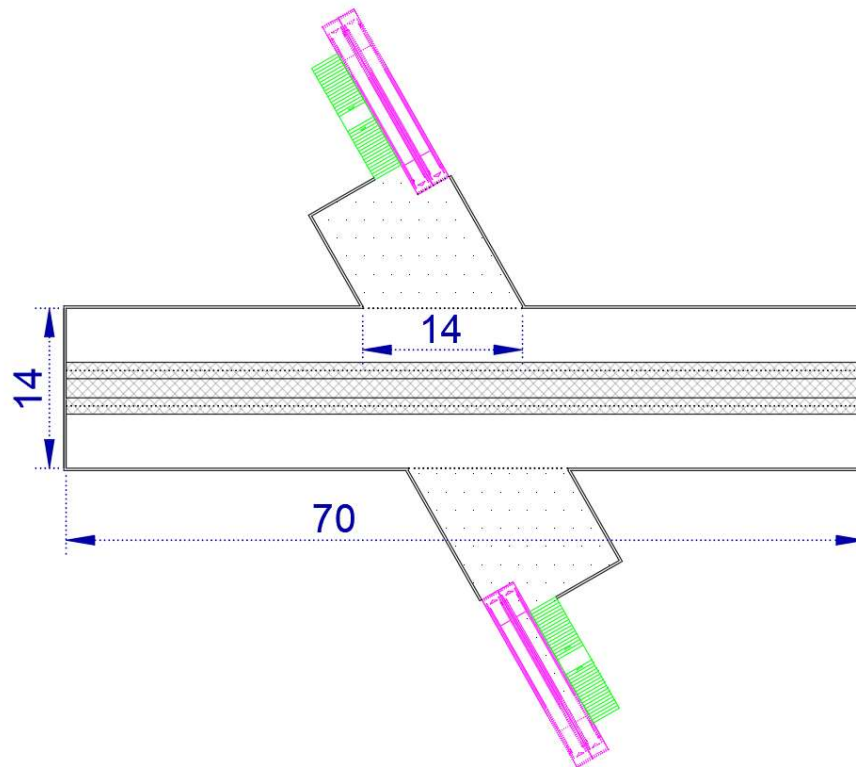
Planta da plataforma da estação Faria Guimarães (dimensões em metros)
